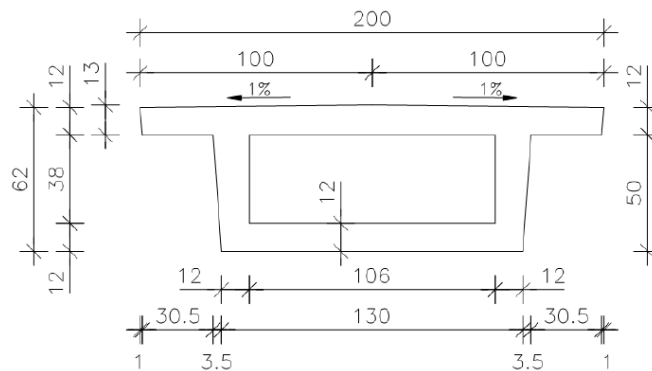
Sección transversal de las vigas principales en [cm] en pasarela Chada.
